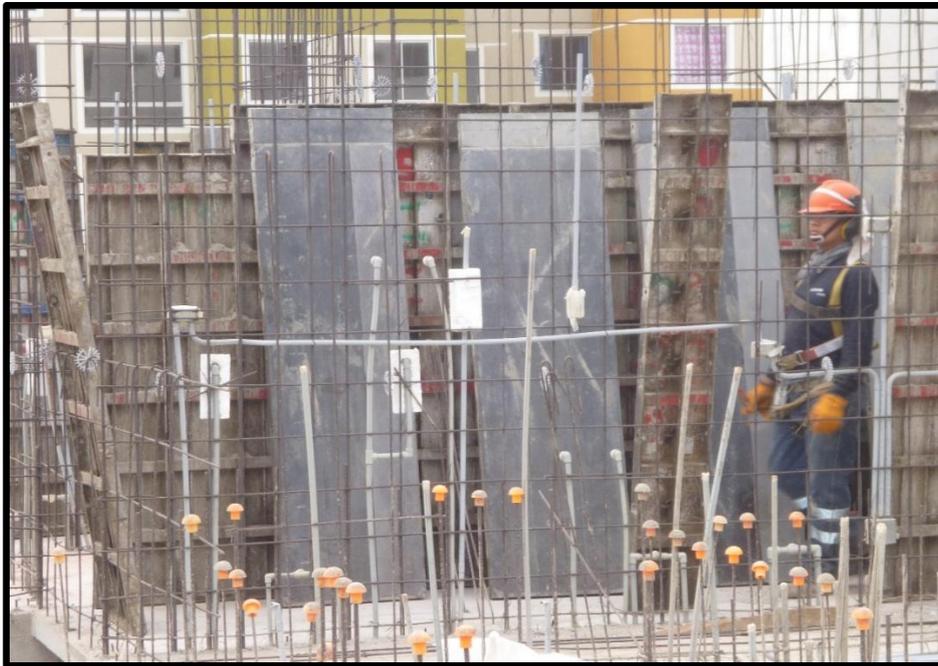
Vista panorámica de las instalaciones eléctricas, de comunicaciones y otros en ductos del block que luego serán cubiertos con drywall.
